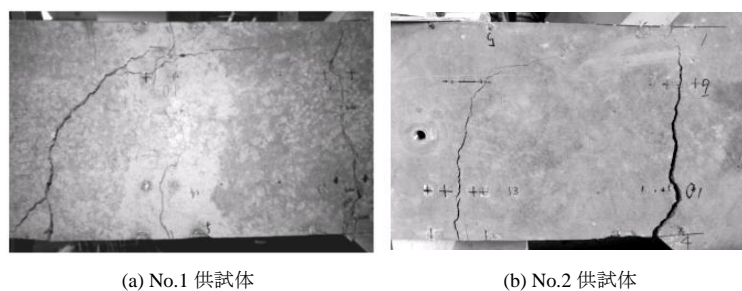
載荷終了時のひび割れ状況（左側）
